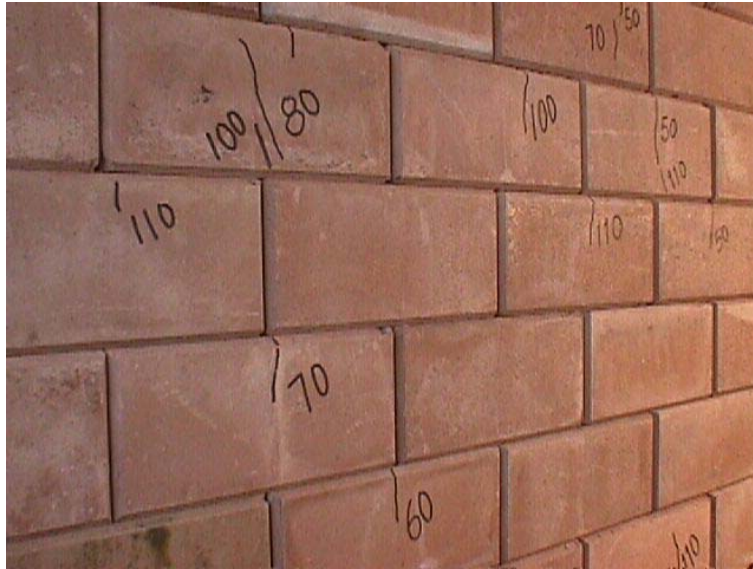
Fissuração em P4 de [4x20] – face sul central
